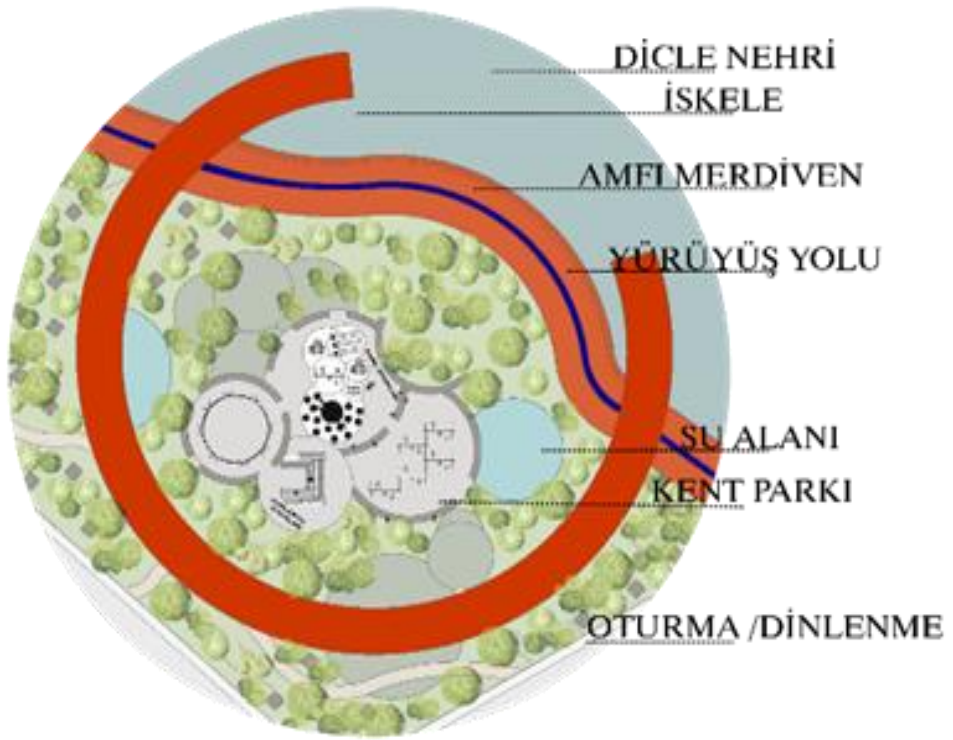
Meydan Mahallesi Tasarım Projesi Vaziyet Planı.
